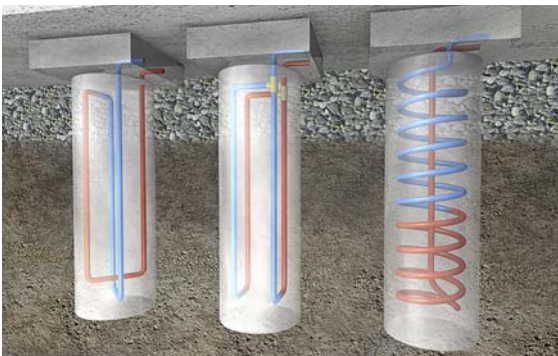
Kollektorrohre im Bewehrungskorb
